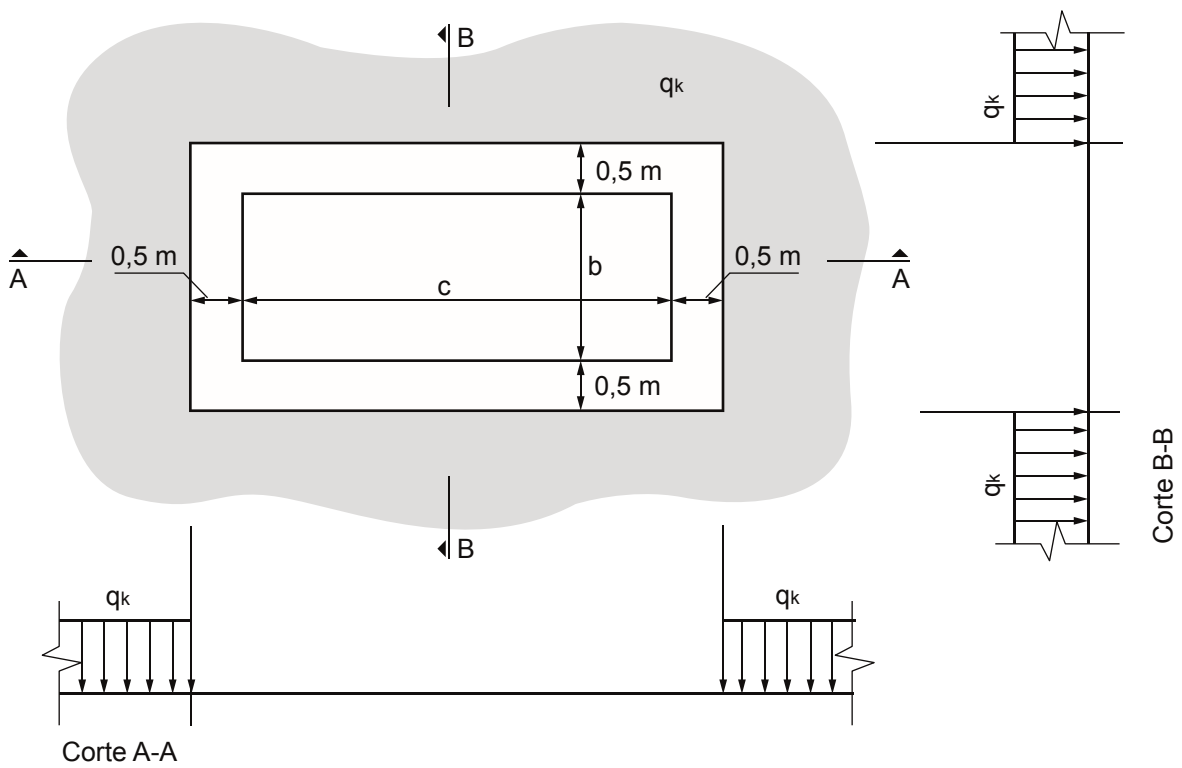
Cargas uniformemente distribuídas ao redor de empilhadeiras ou minicarregadeiras
